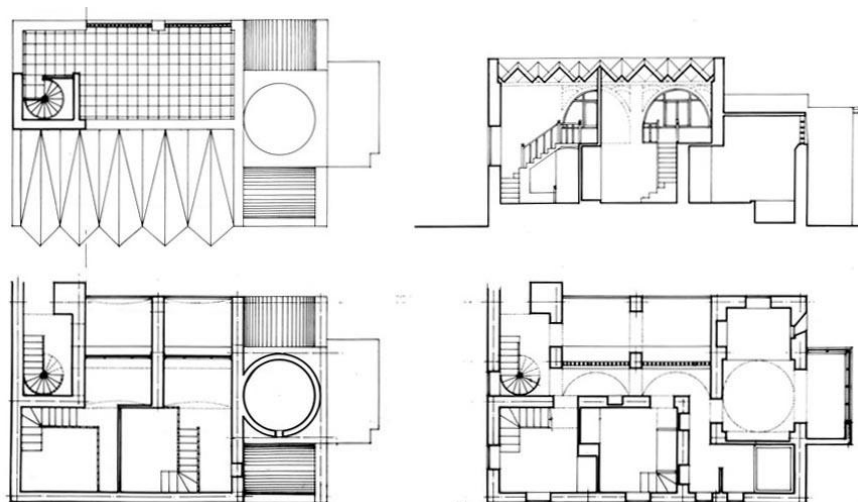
Plano de planta baja, 1ª planta y cubierta. Sección longitudinal
